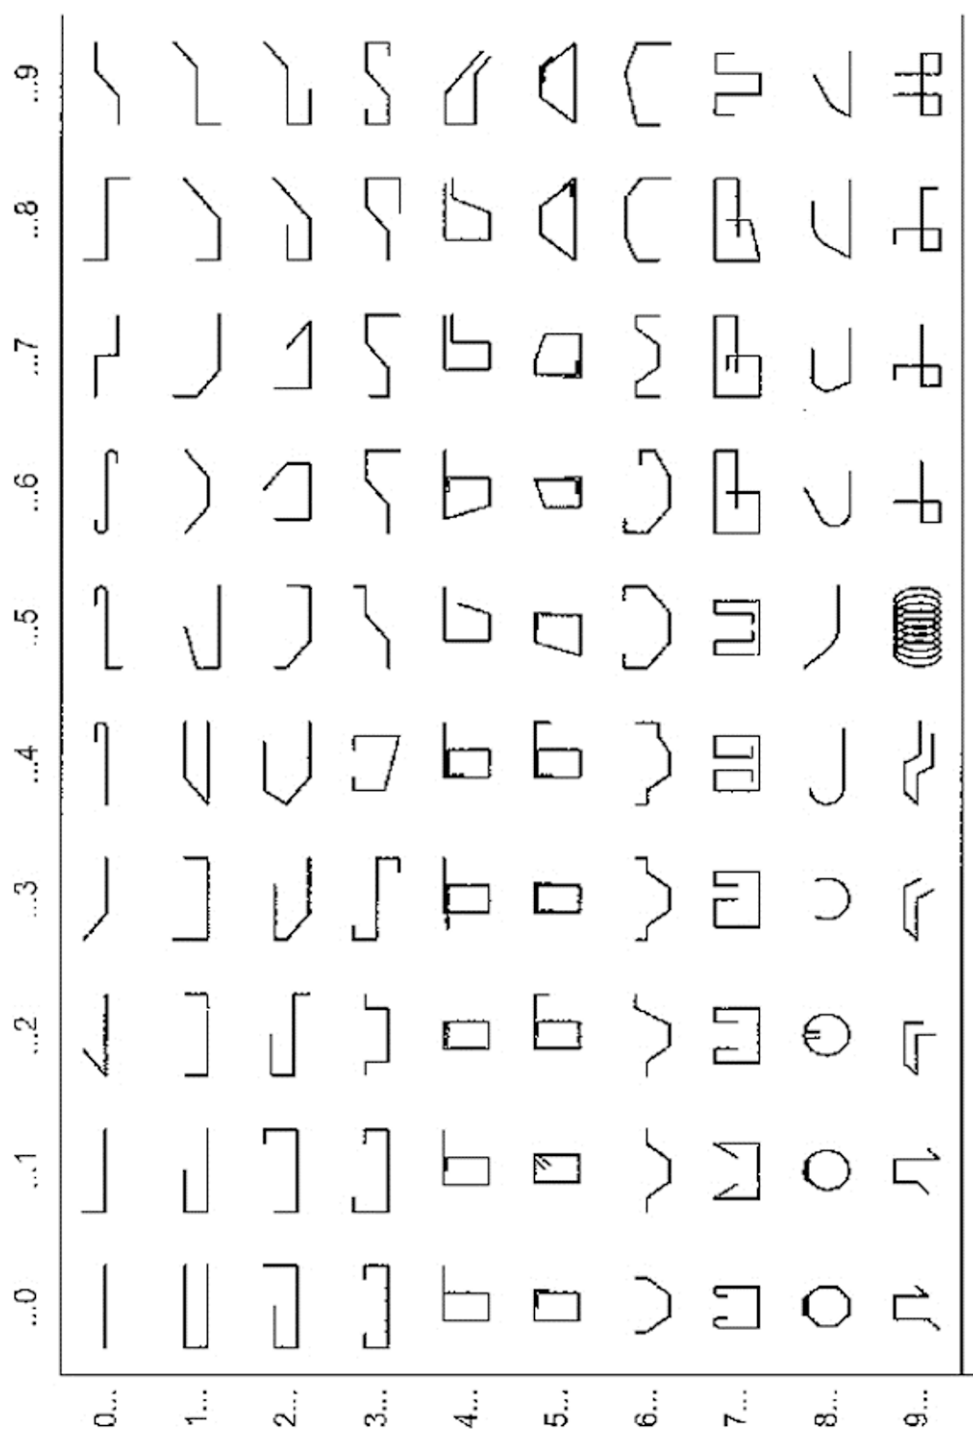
Menge der Biegeformen (oder Betonstahlpositionen)
